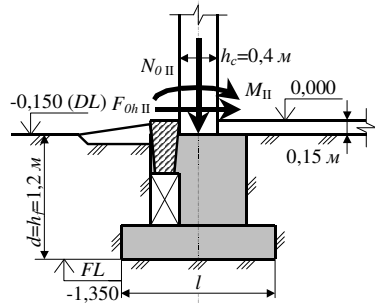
Схема до визначення розмірів подошви стовпчастого фундаменту мілкого закладання під позацентрово навантажену колону крайнього ряду
